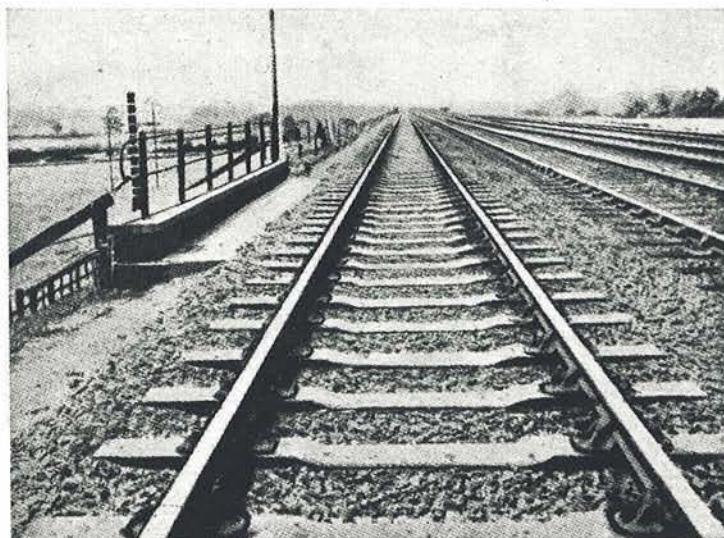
Vista de una vía férrea montada sobre traviesas de hormigón pretensado.
